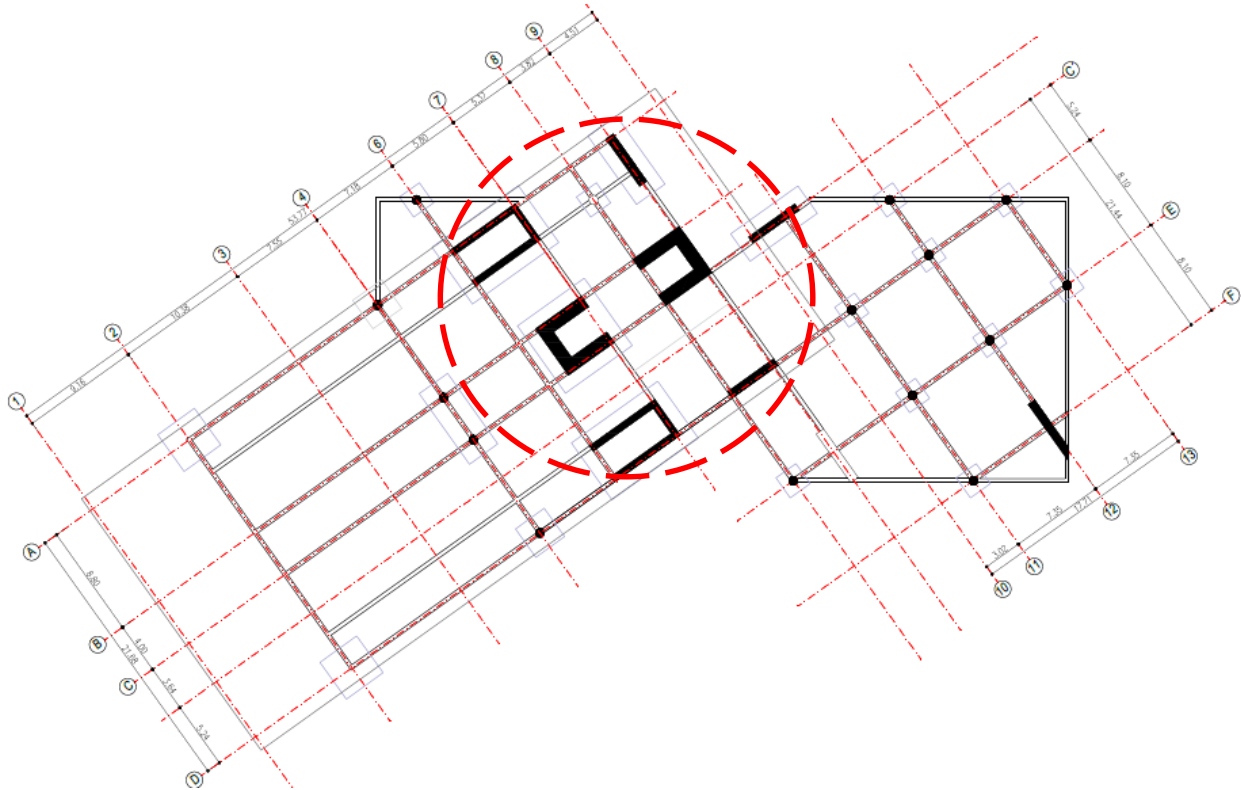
Planta Estructural 3er Piso - Sala de la Música
